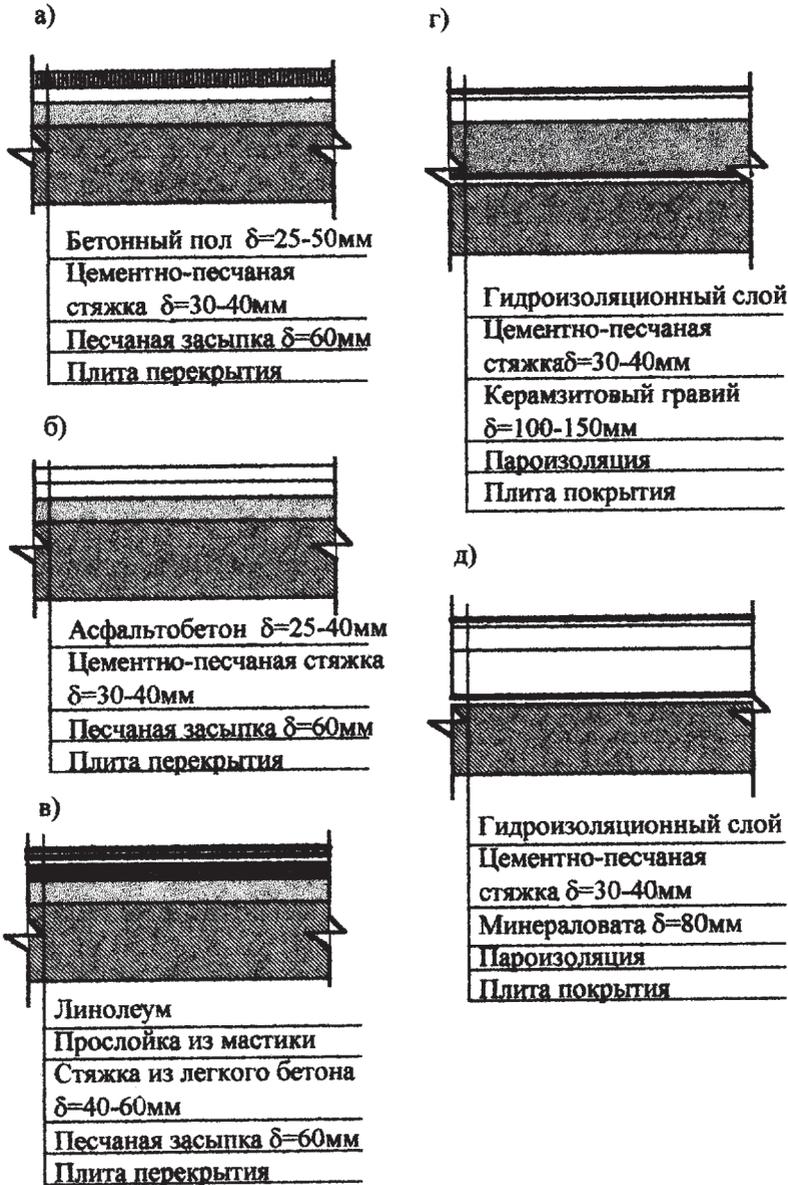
П. Примеры разрезки перекрытий (а,б,в) и покрытий (г,д)
